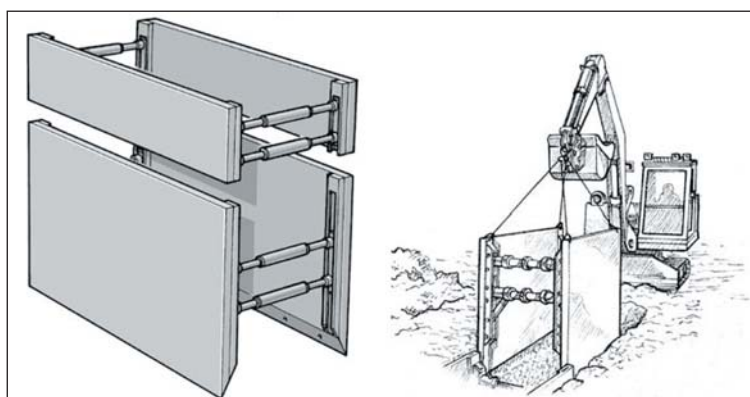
Устройство траншейной опалубки без участия рабочих и без необходимости спускаться в котлован
